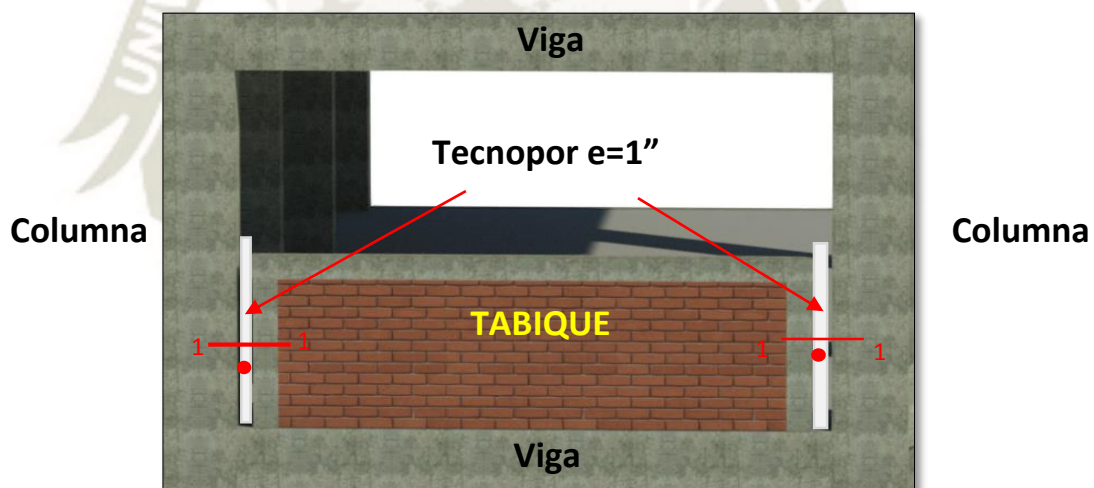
Pórticos con tabiquería aislada con tecnopor espesor 1".
